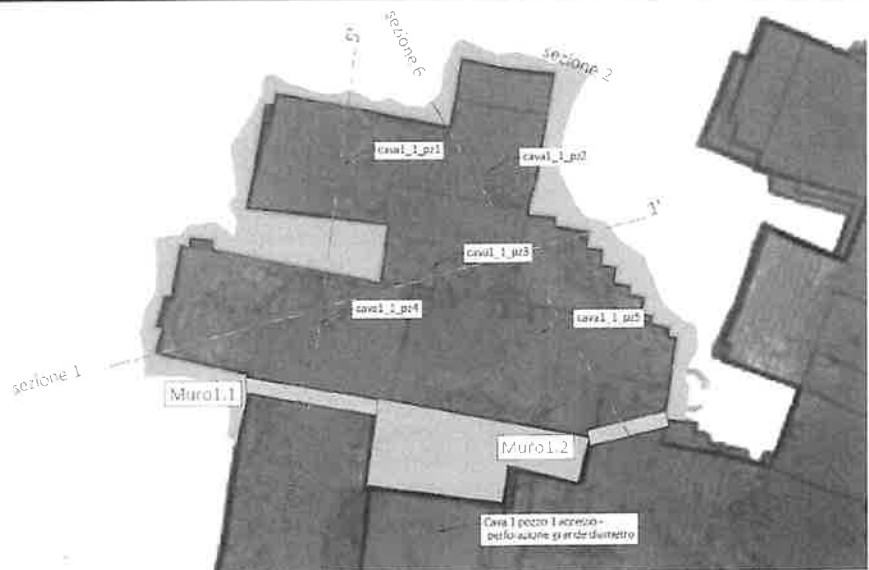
Dettaglio della planimetria di Cava 1 - Area 1
